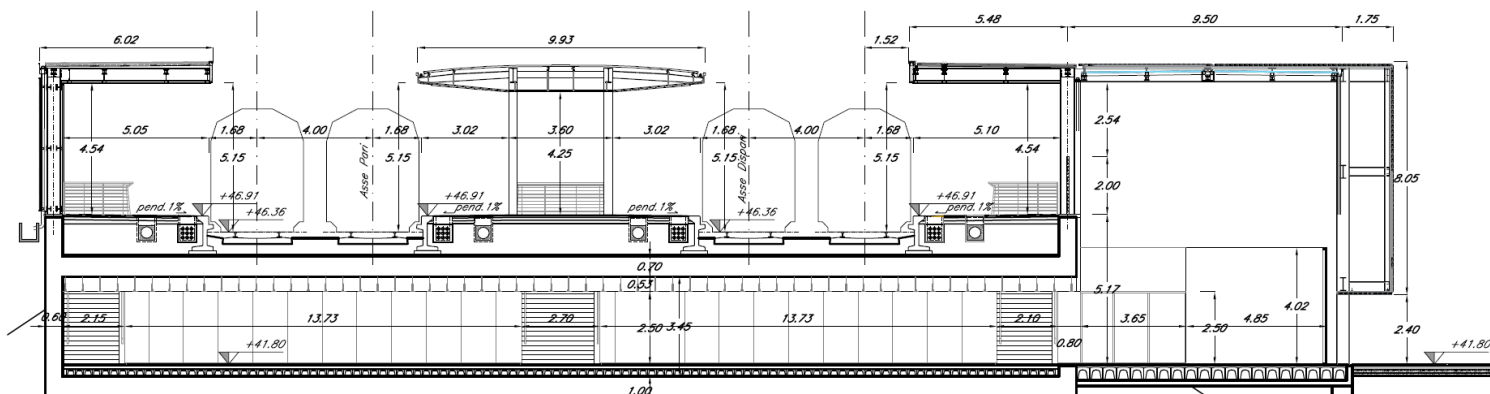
Sezione trasversale stazione di S. Alessio (Rif.[26])
